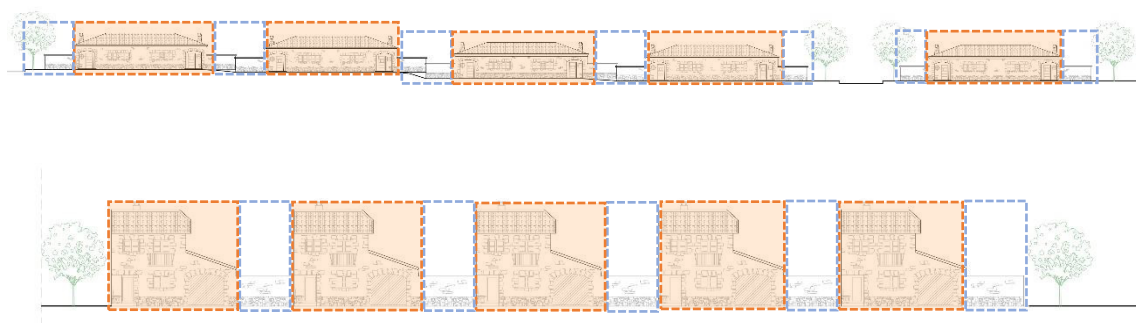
Alzado tipologías de viviendas de Sodeto. Fuente: Elaboración propia
